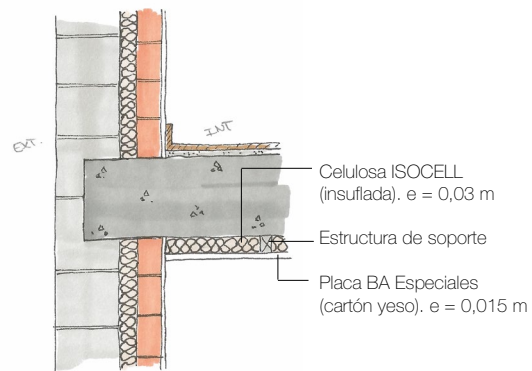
Encuentro forjado con cerramiento con sistema de aislamiento bajo el forjado (autoría propia).
